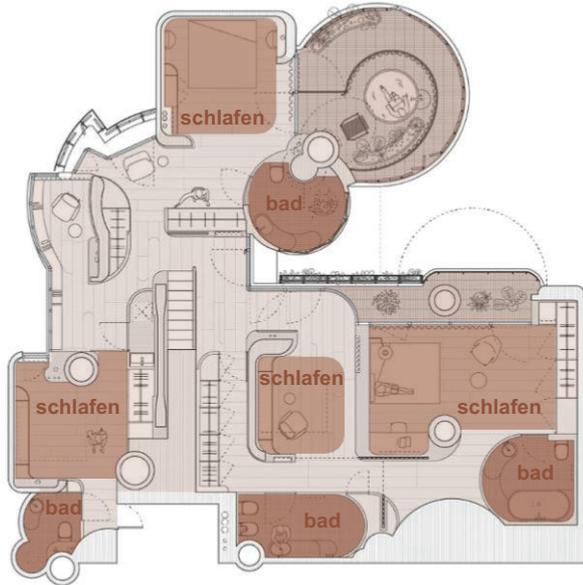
Grundriss | Schlafen, Arbeiten, Entspannen
